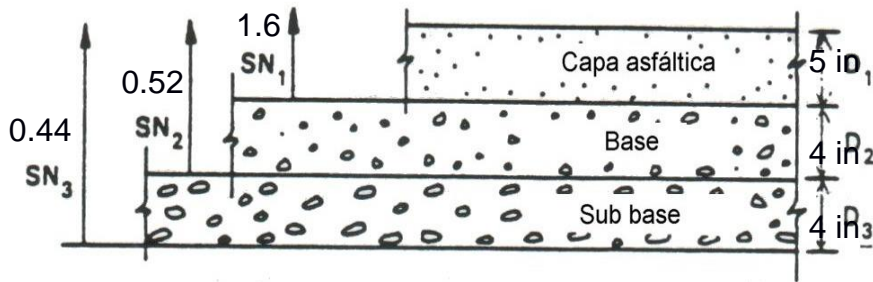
Espesores de las capas del Pavimento en función al número estructural SN. [Castro & Fajardo, 2023]
